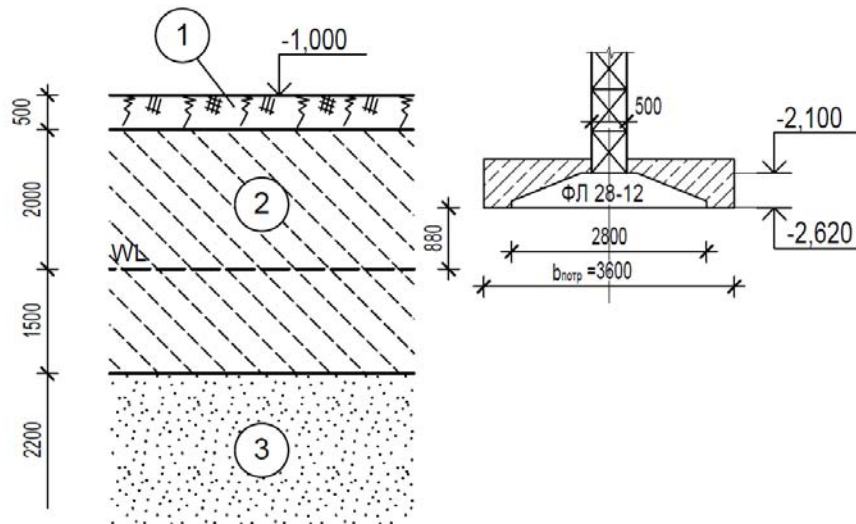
Розташування фундаментів мілкового закладання, підсилених банкетами, у ґрунті
